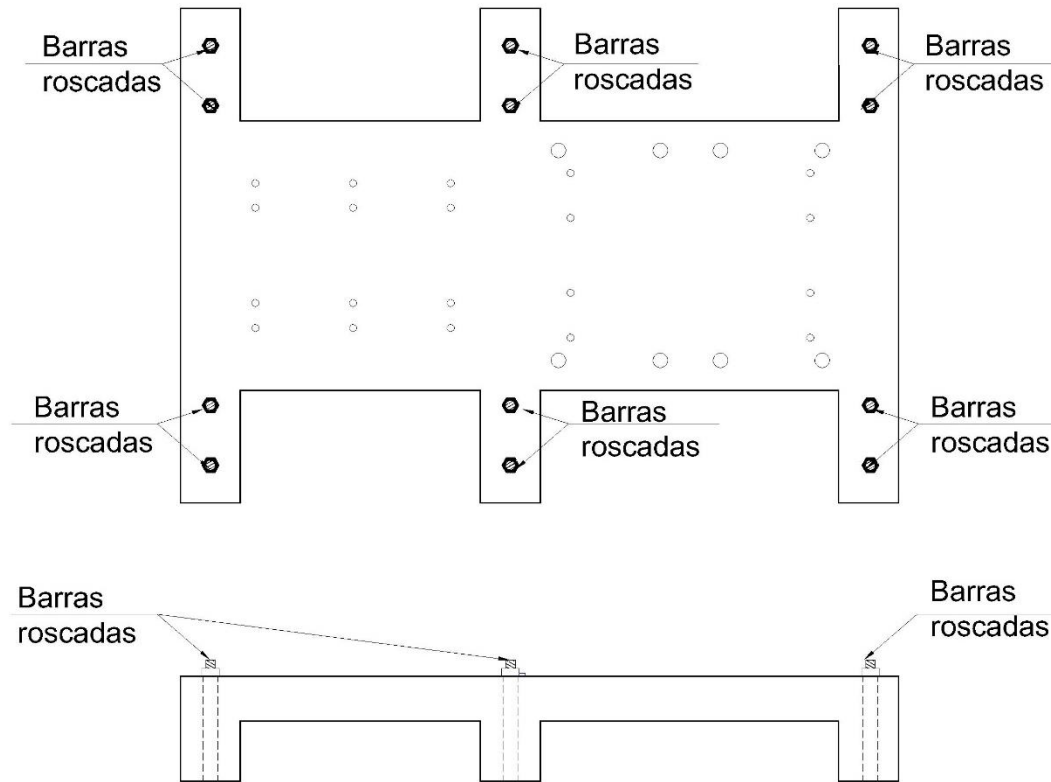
Anclaje de losa de reacción móvil a losa de reacción existente.
